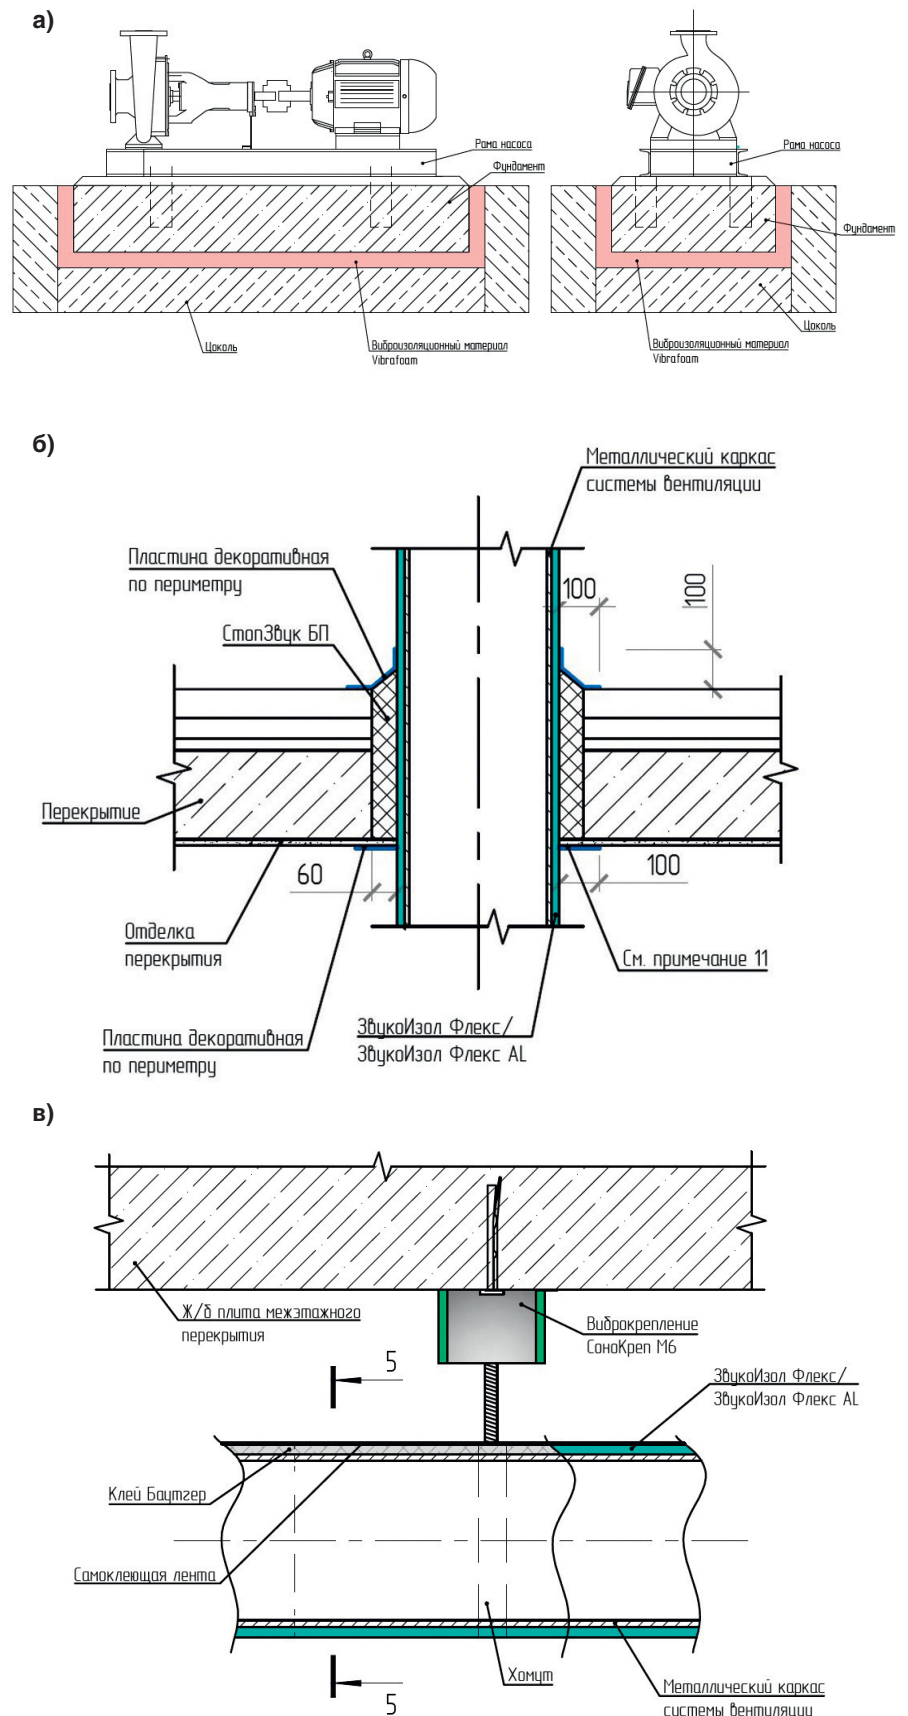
Примеры готовых узлов: а) устройство плавающего основания под оборудование; б) узел прохода труб через ограждающую конструкцию; в) узел крепления трубопровода через виброподвесы
